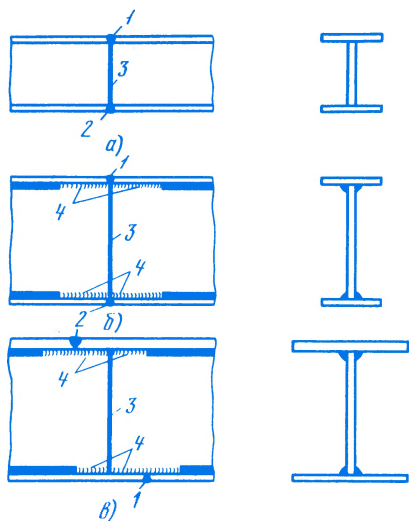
Порядок сварки монтажных стыков балок:
